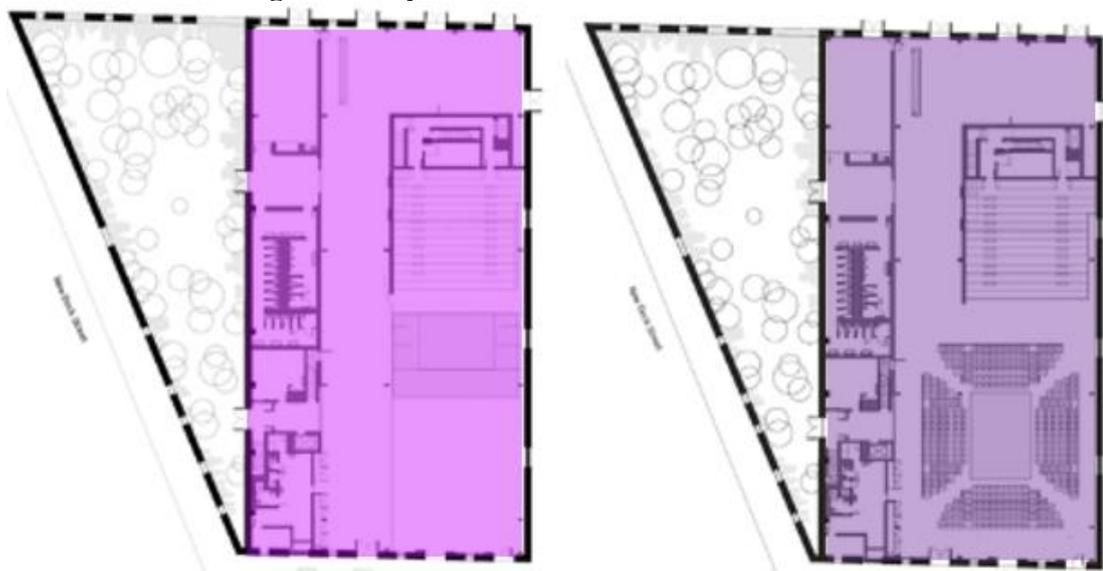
Layout 1 e 2 - Teatro St. Ann's Warehouse
